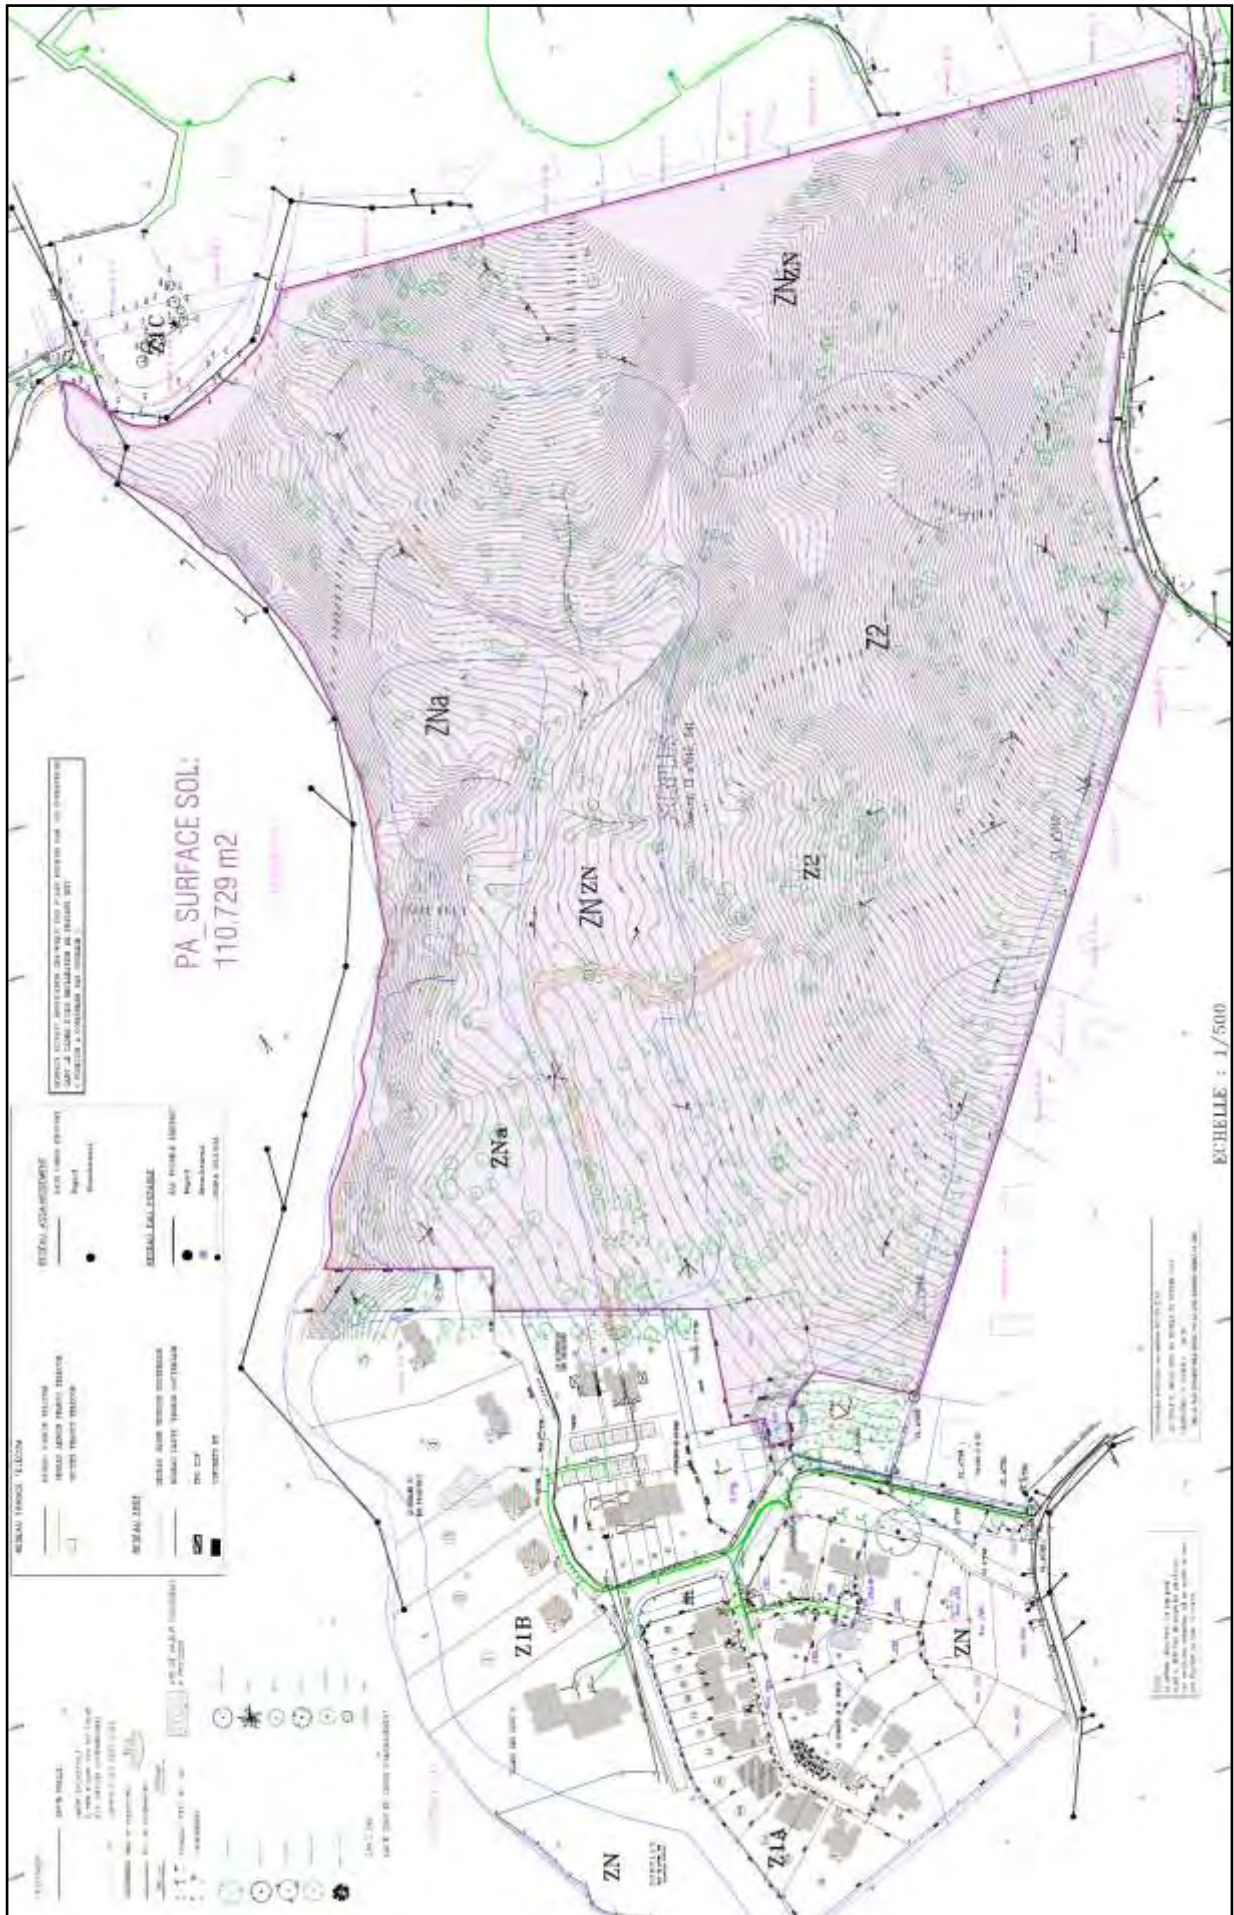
Plan de masse du projet (extrait plan de l'architecte)
